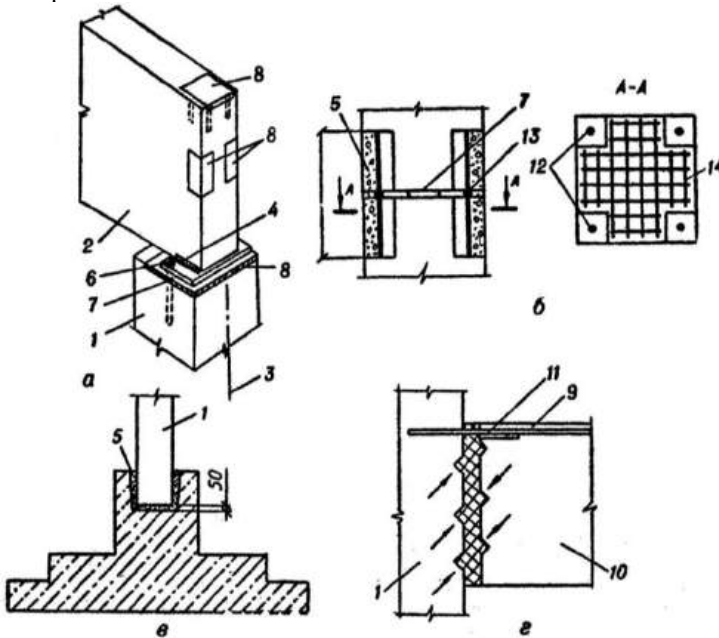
Стики збірних елементів: *а* – ригеля з колоною; *б* – жорсткий стик збірних колон із ванним зварюванням арматурних випусків; *в* – колони з фундаментом; *г* – балки з колоною за допомогою бетонних шпонок;
